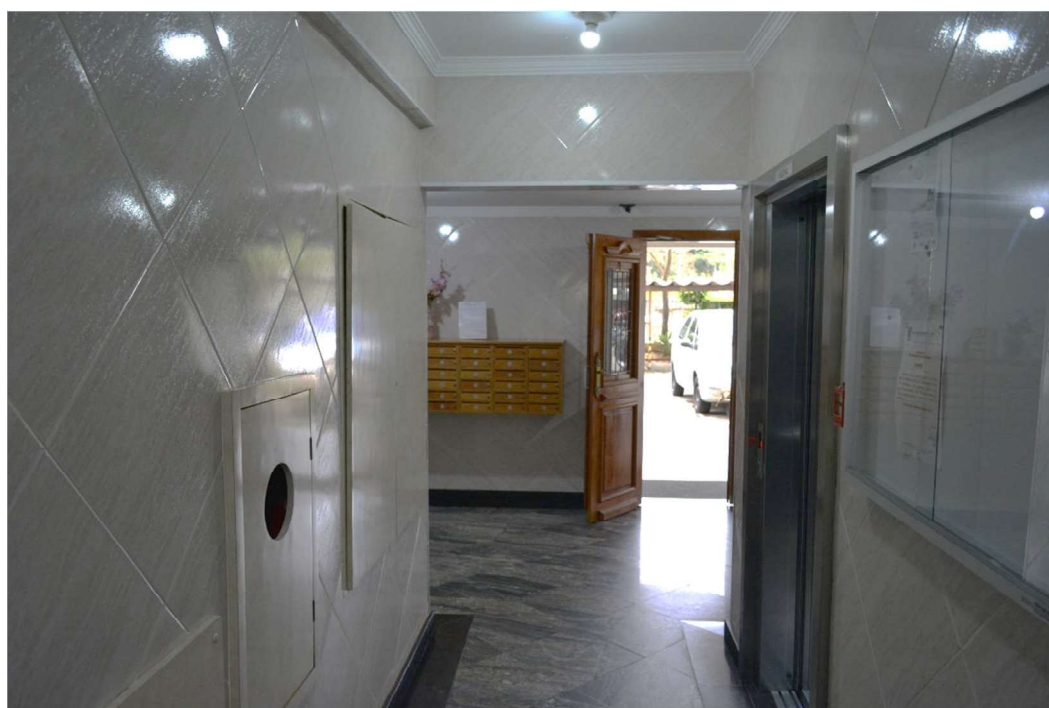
HALL DE ENTRADA, VISTA OPOSTA.
